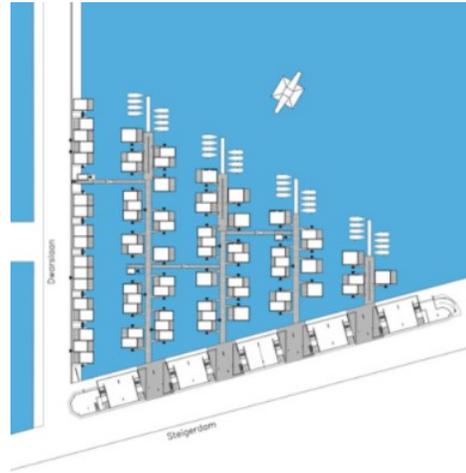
Plan maestro análogo, Fuente: (Guerra, 2019)
